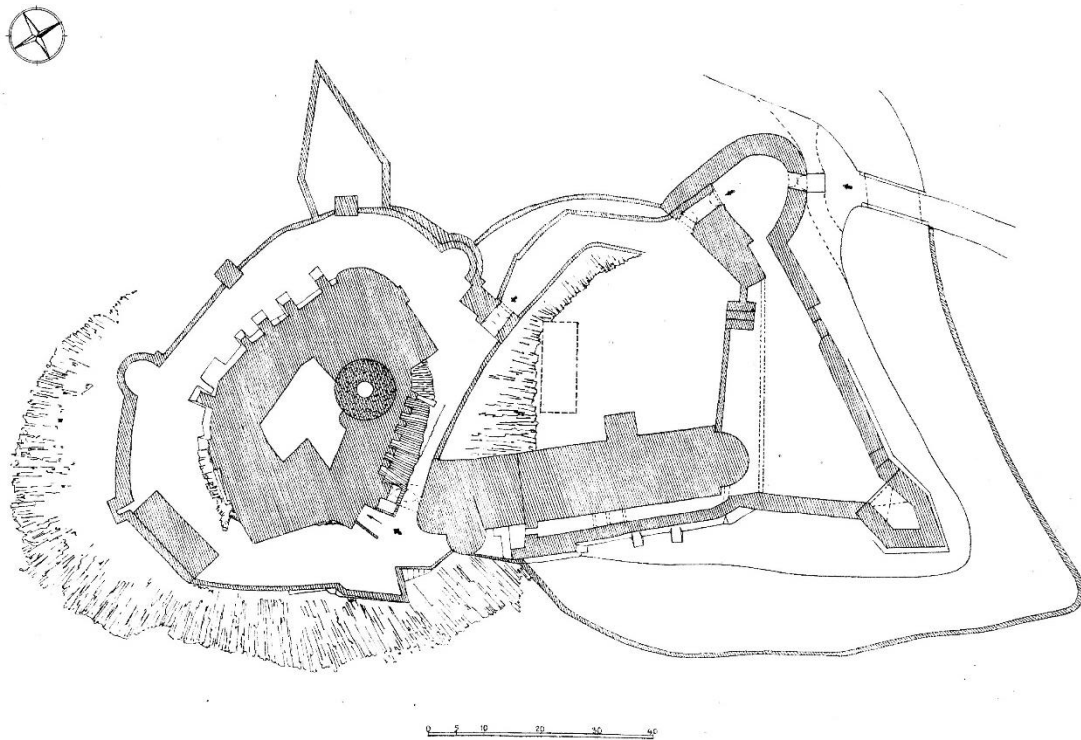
Frýdlantský hrad a zámek v 16. stol. [3]
